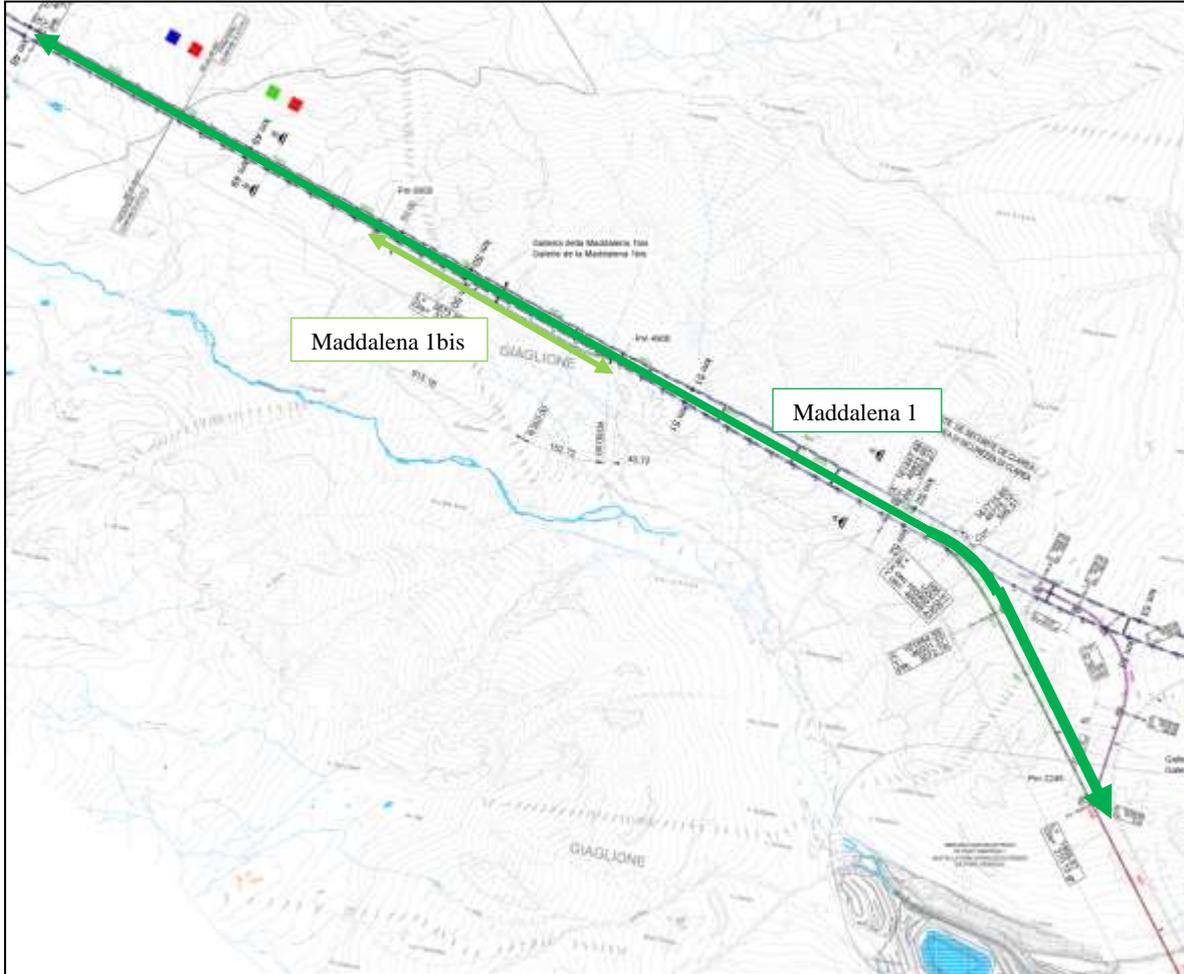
Planimetria delle zone di stoccaggio in Maddalena 1 e Maddalena 1bis (PRV\_C3A\_3803\_26-48-10)
